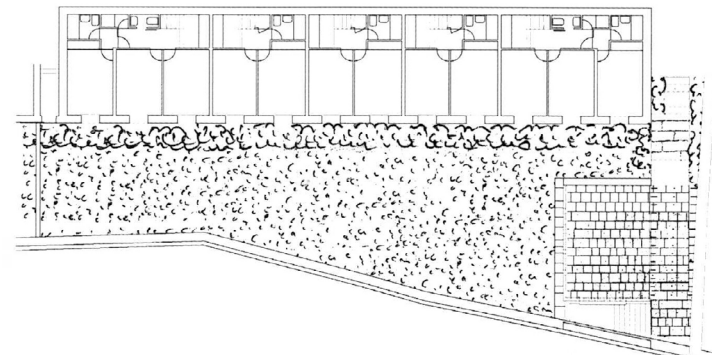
Segunda planta alta de la Vaqueria del Carmen de Abaixo
